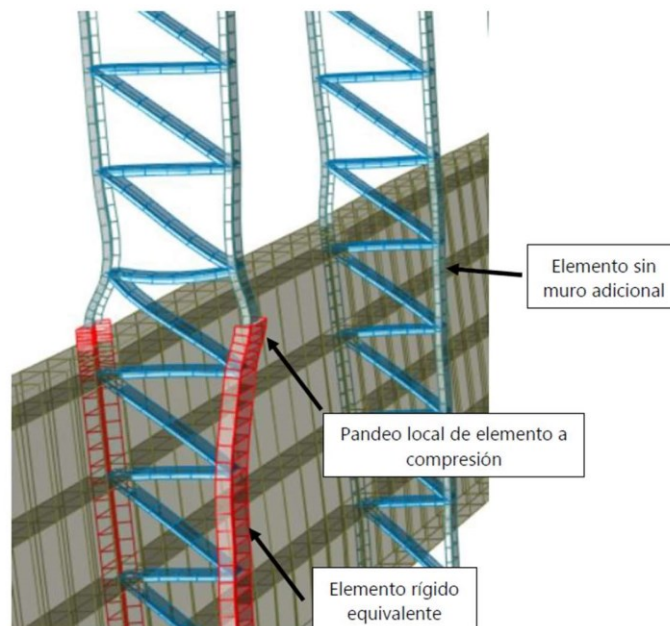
Modelo estructural con la rigidez adicional proporcionada por el muro
